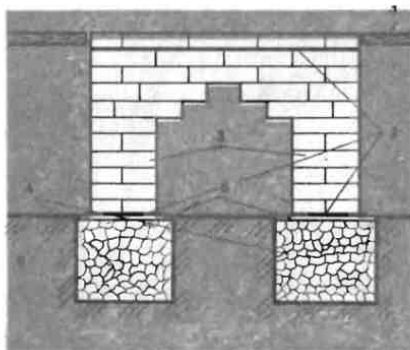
Фундамент из двух столбиков, соединенных путем напуска кирпичей с отдельными фундаментами в грунте
